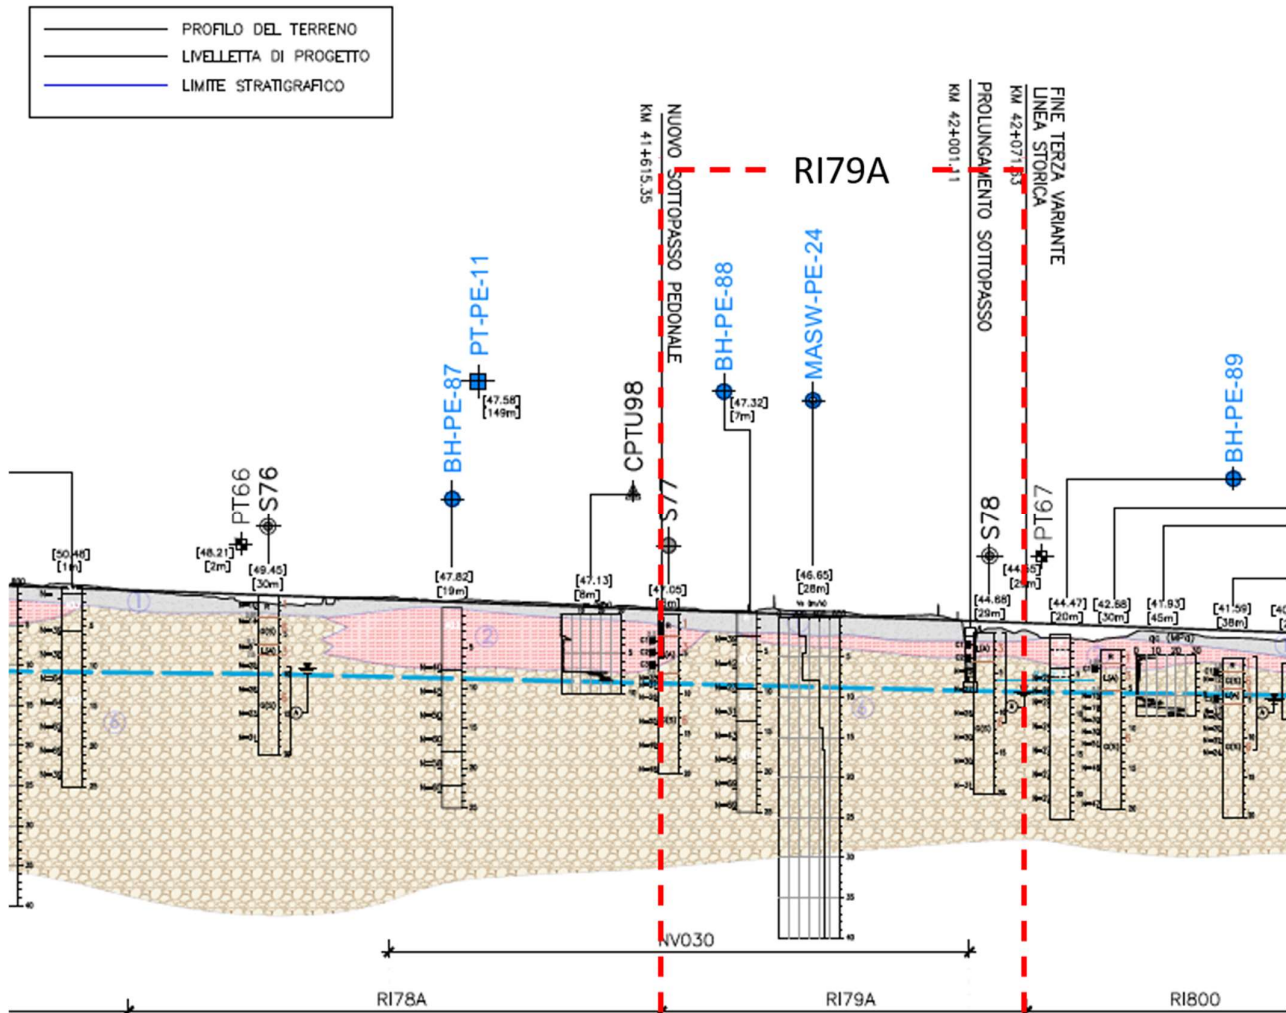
Profilo Geotecnico Rilevato RI79A, estratto dal Profilo Geotecnico Generale
